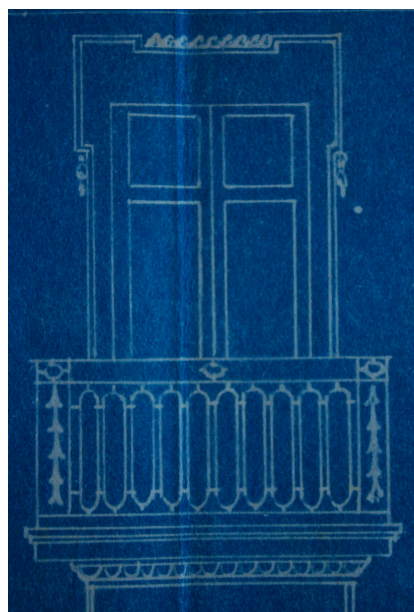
Remate de jambas. Unid. Instal 608-28. Archivo La Laguna. Arqto. Javier Felíp. Foto: el autor.
